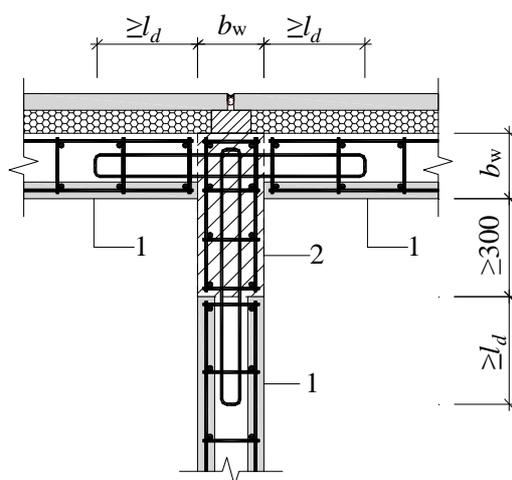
钢筋笼双板叠合墙构造边缘构件及其与钢筋笼双板叠合墙连接构造示意
